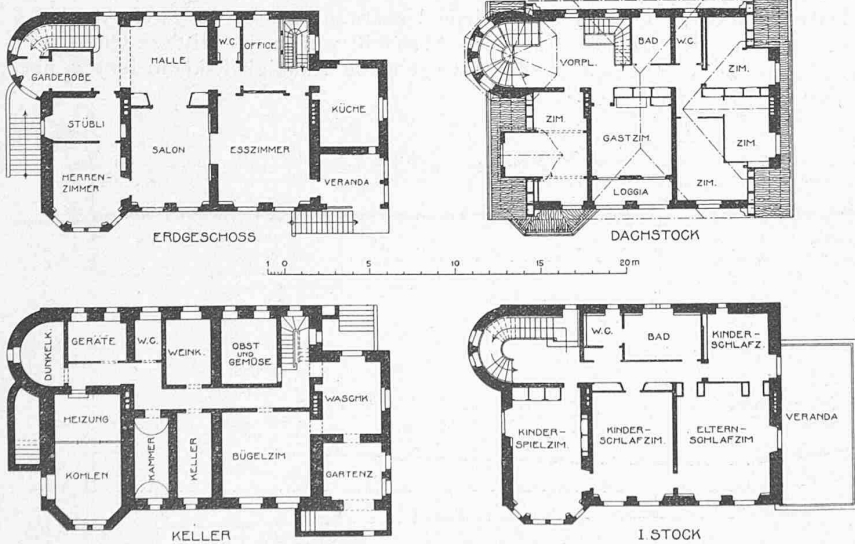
bis 6. Das „Waldschlössli“ bei Glarus. — Grundriss 1:400.
